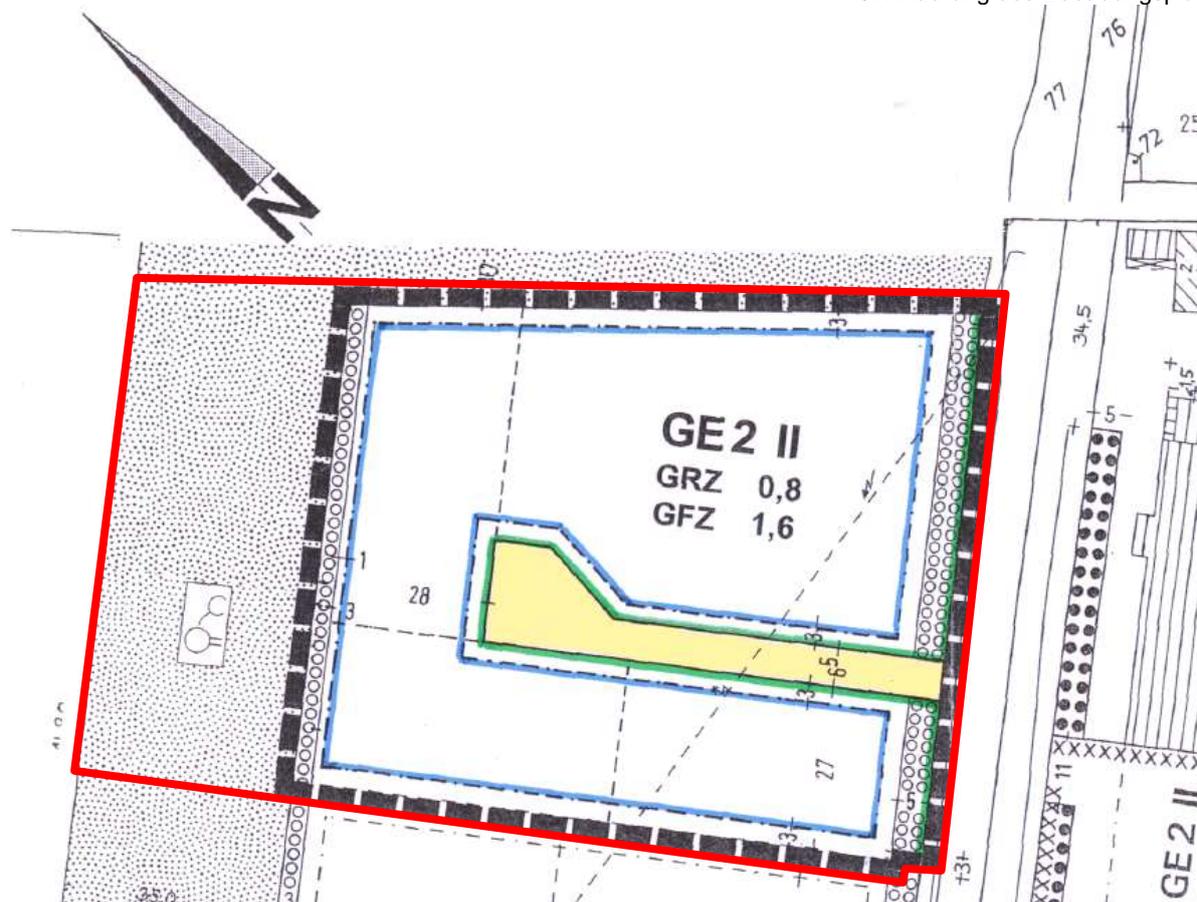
Auszug aus dem Bebauungsplan B13 mit Geltungsbereich der 3. Änderung (rot); Quelle: Gemeinde Niederzier
